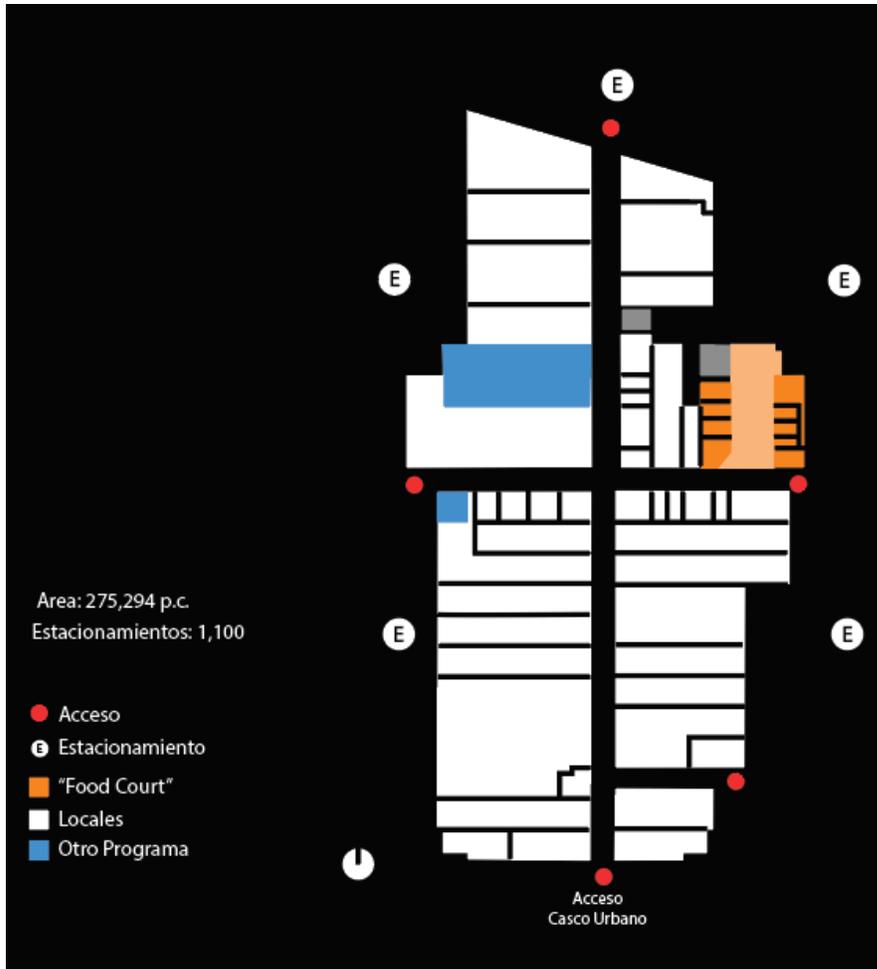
Gráfica que muestra tipología organizacional del Cantón Mall en planta. Trabajada por el autor.
